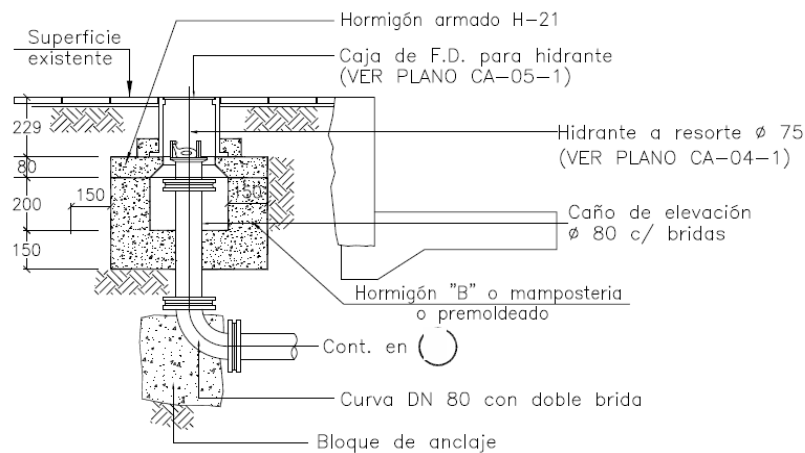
Esquema detallado para la colocación de hidrantes.
